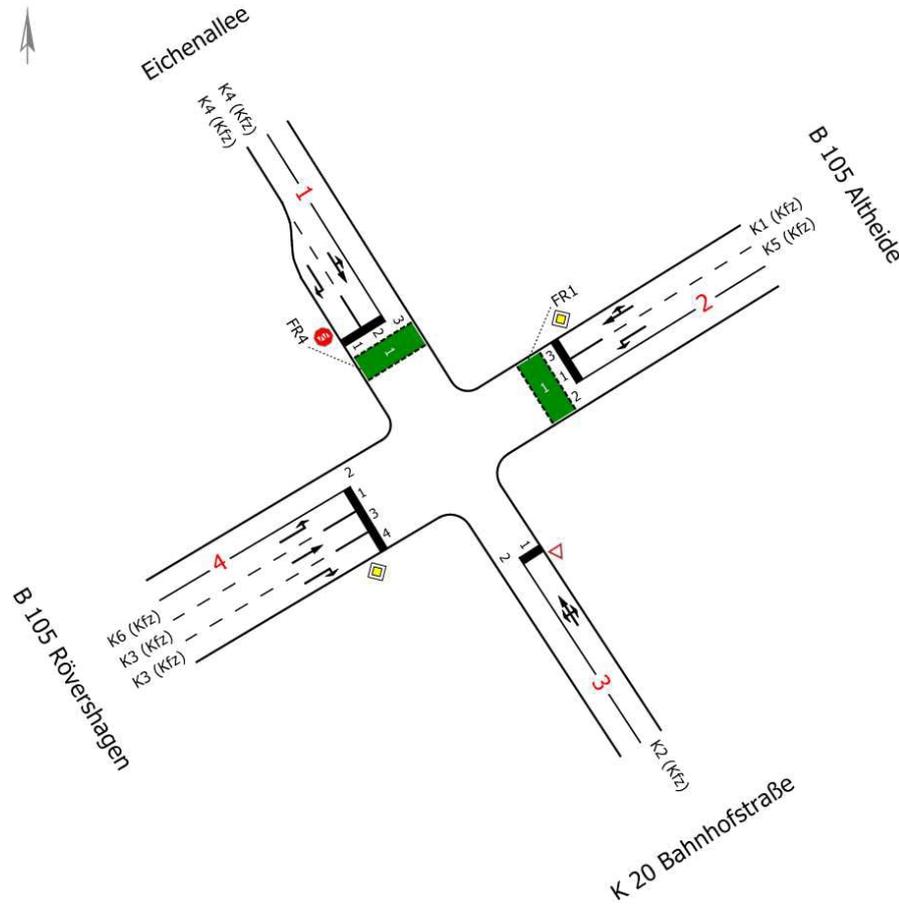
Knotenpunktschema KP10 - Planfälle
